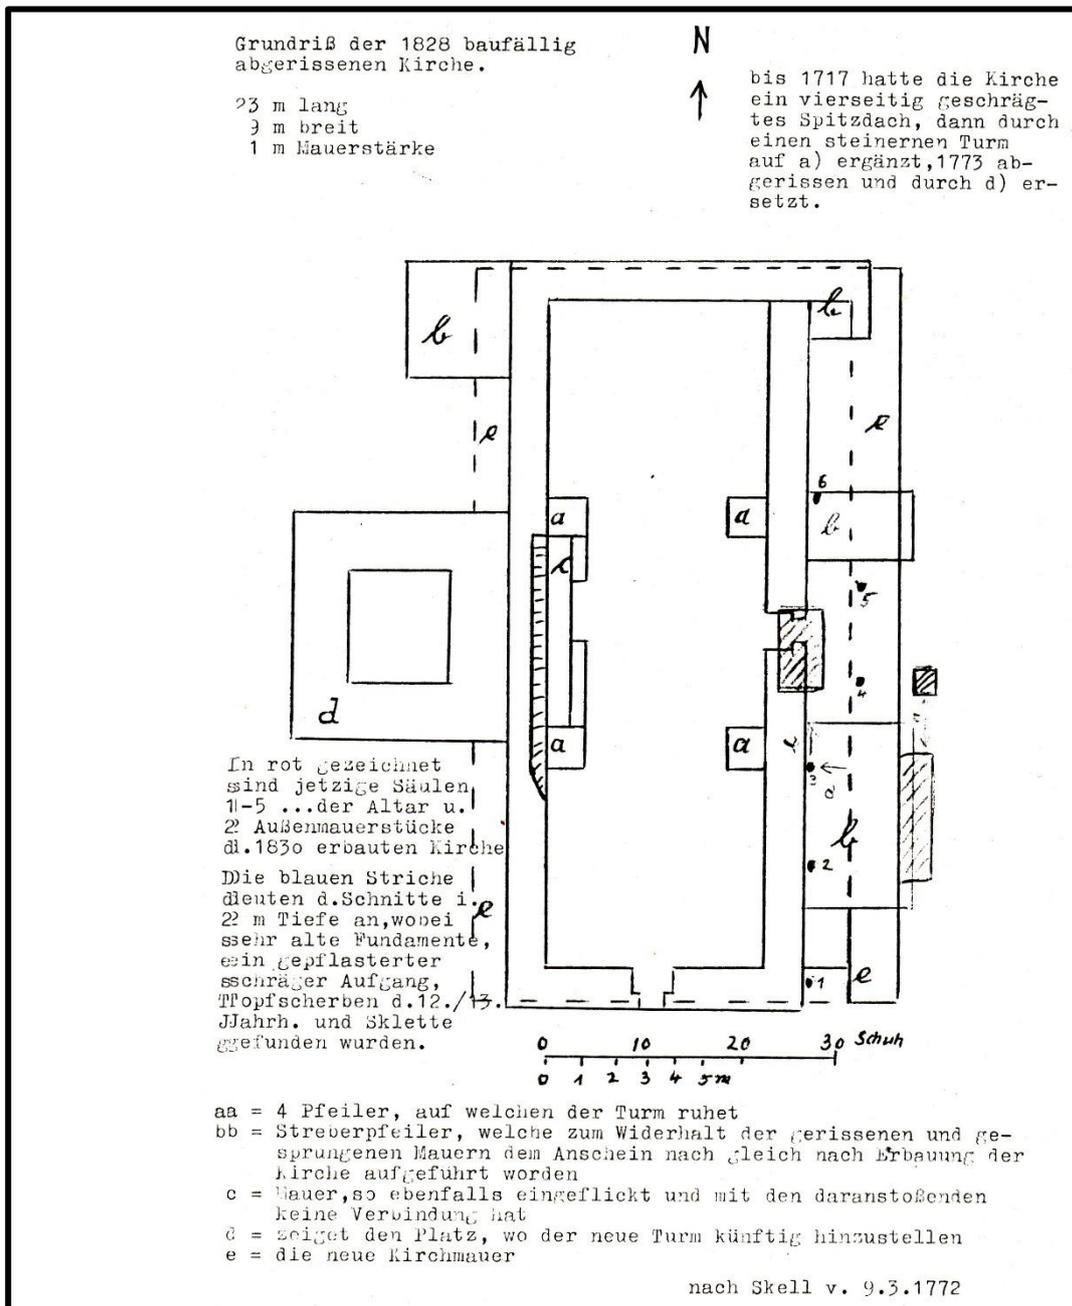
Grundriß der 1828 abgerissenen Kirche
